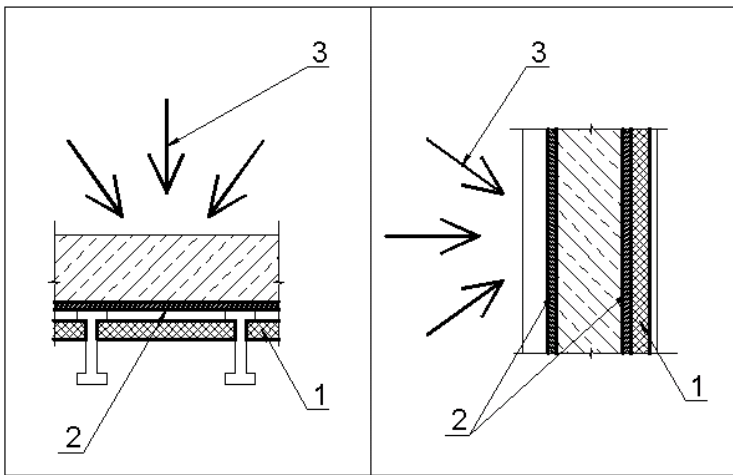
Утепление опалубки. 1 – слой утеплителя, 2 – конструкция опалубки, 3 – направление теплообработки
